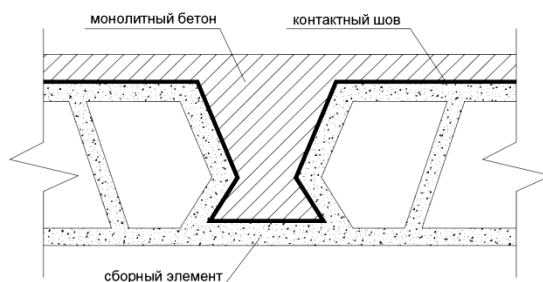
Контактный шов при сборно-монолитном строительстве (на примере сборно-монолитного перекрытия «ДАХ»)
